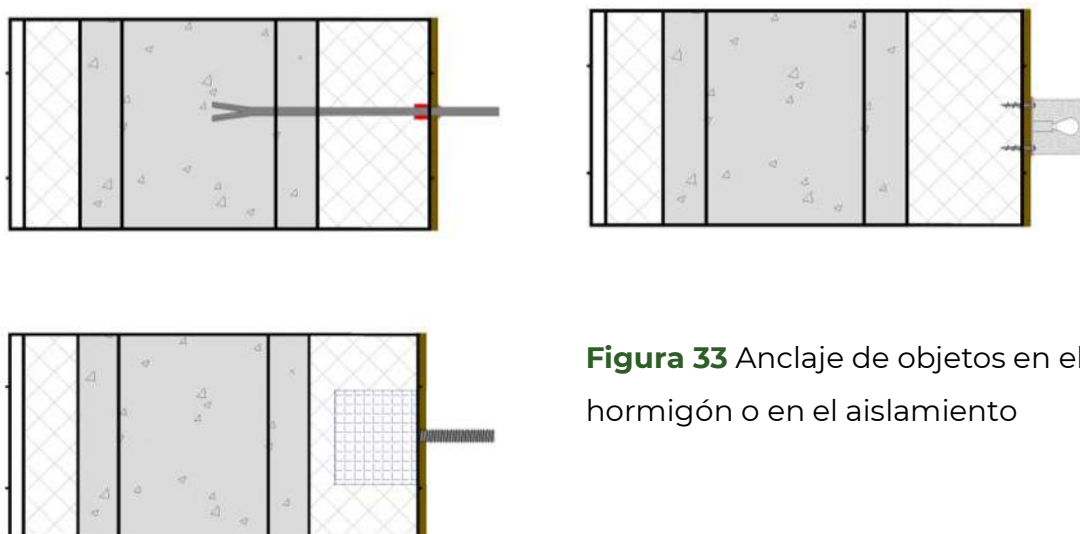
Anclaje de objetos en el hormigón o en el aislamiento
